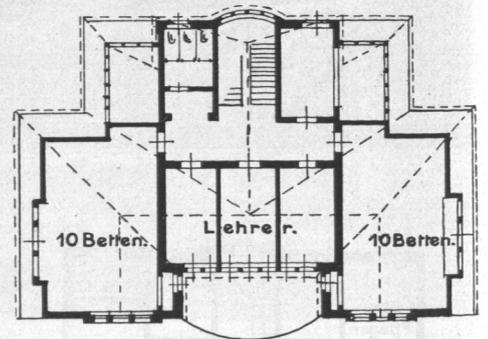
Irrenanstalt Friedrichsberg, Haus für jugendl. männliche Kranke, Obergeschoß, Grundriß.
